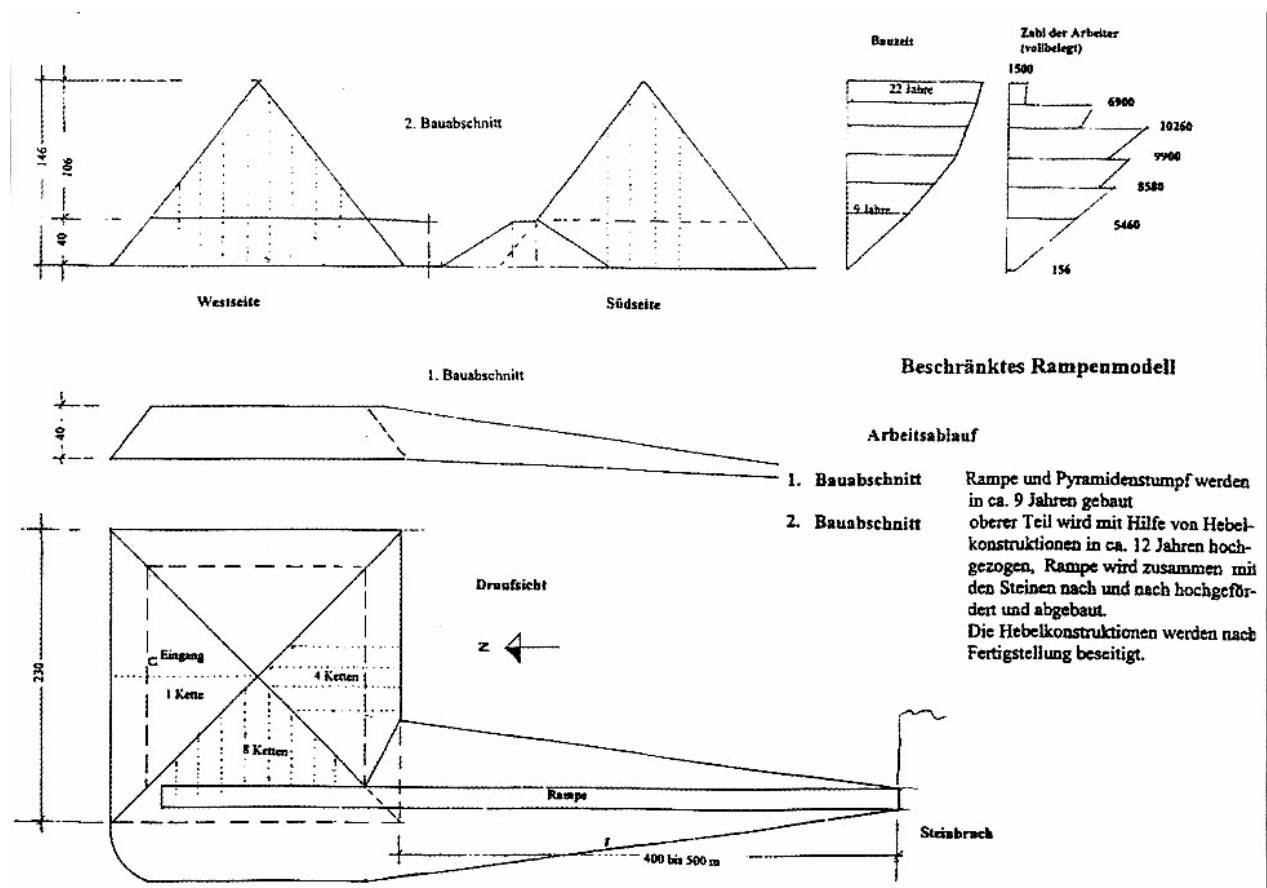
Beschränktes Baurampenmodell nach Bormann
